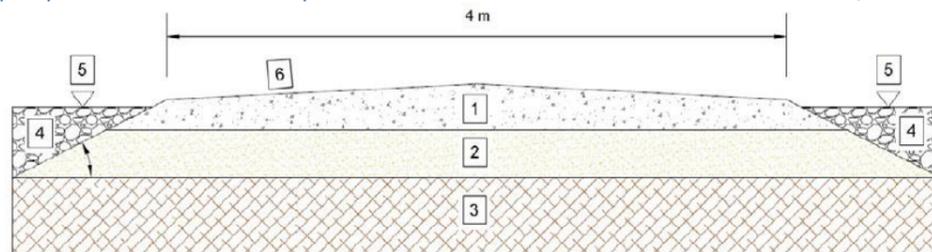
Coupe transversale des chemins d'accès (Source : NORDEX)
